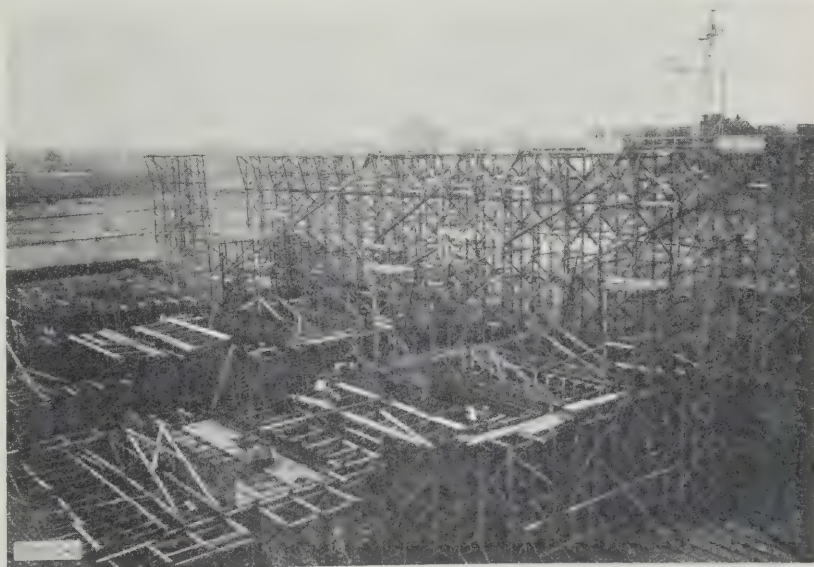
Betonieren der Schleusensohlenblöcke, im Hintergrund Hochgerüst mit Betontrichtern und Gießbrinnen.
